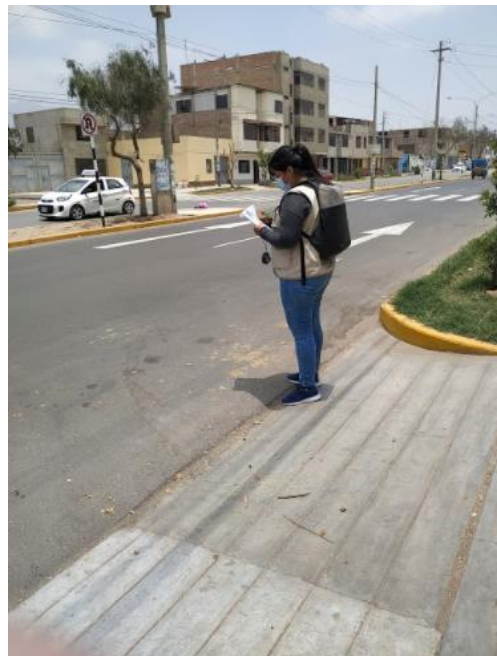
Fisuras Longit. y/o transversal en la Av. Miraflores
